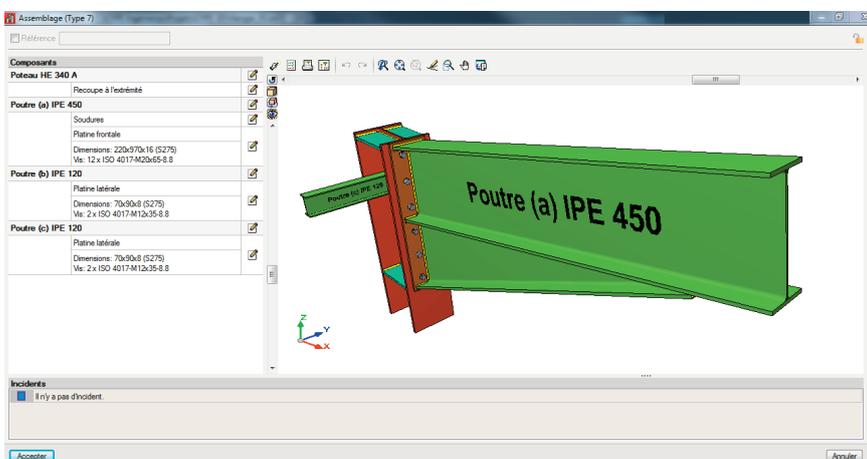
Edition d'un assemblage poteau - arbalétrier
